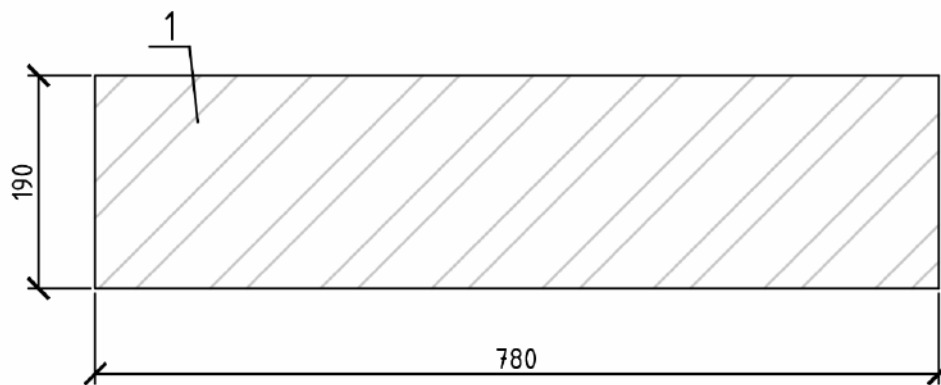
Схема сечения стены по кладке без утеплителя без дефекта
